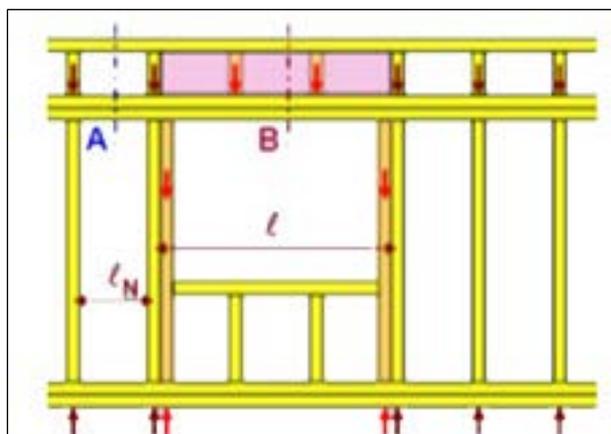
Schema di un architrave in una struttura intelaiata di parete in edifici multipiano.
